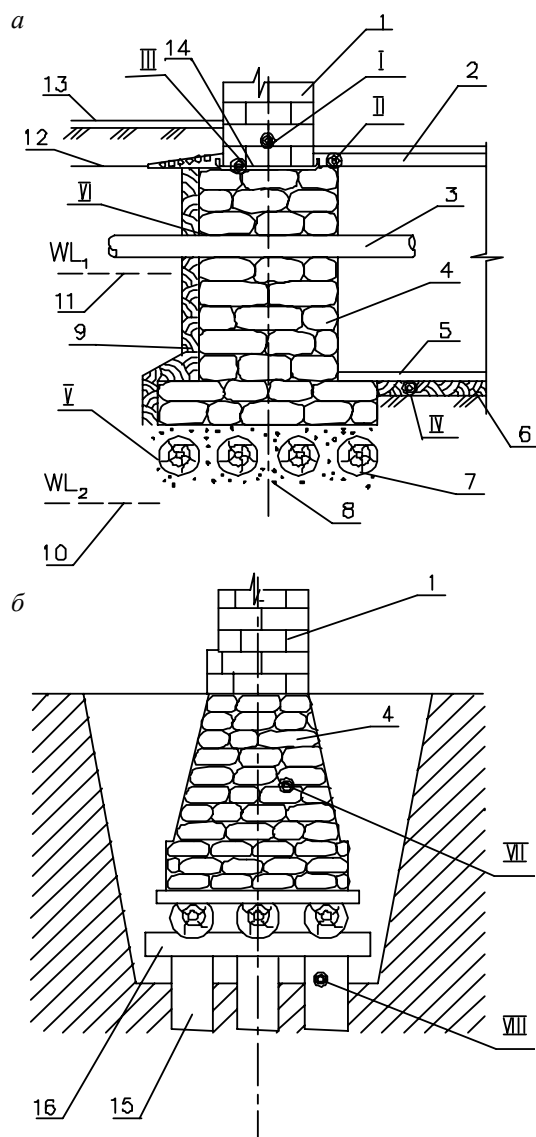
Традиционные конструкции фундаментов старых зданий с характерными дефектами (I – VIII – см. таблицу): а – бутовый фундамент на естественном основании; б – фундамент на сваях; 1 – кирпичная кладка стены; 2 – надподвальное перекрытие; 3 – труба, пропущенная через фундамент; 4 – бутовая кладка на растворе; 5 – пол подвала; 6 – гидроизоляция пола; 7 – деревянные лежни; 8 – каменная забутовка; 9 – гидроизоляция фундамента; 10 – горизонт подземных вод на момент реконструкции; 11 – то же на момент строительства; 12 – старая планировочная отметка; 13 – новая планировочная отметка с поднятием культурного слоя; 14 – старая противокapиллярная гидроизоляция; 15 – деревянные сваи; 16 – деревянный ростверк
